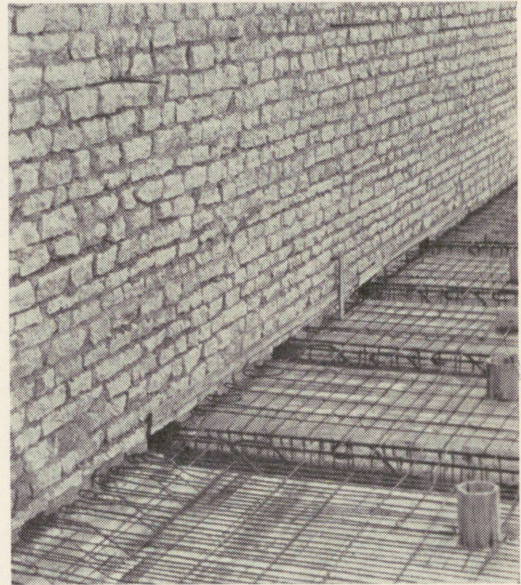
Плитняковая стена строящейся фабрики. Для опоры жел.-бетонного перекрытия в стене оставлены гнезда для балок и желобок для плиты.
